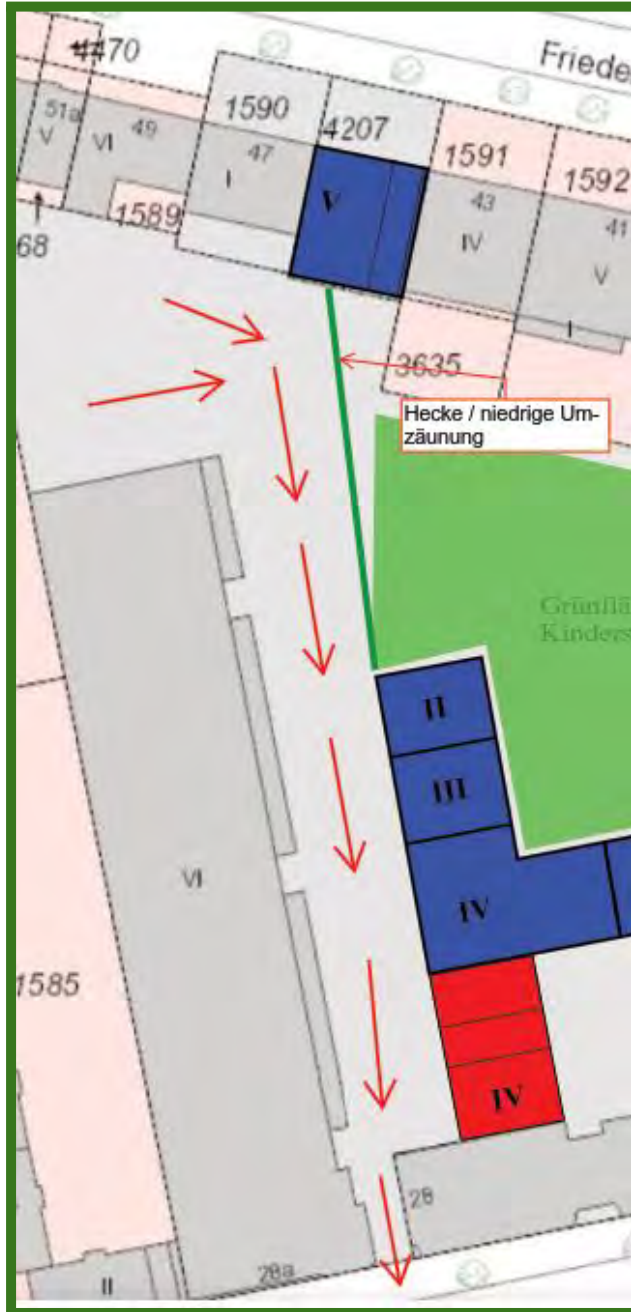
Zu-/Ausfahrt Tiefgarage Behringstraße 28a / Gewerbebetriebe 28a
